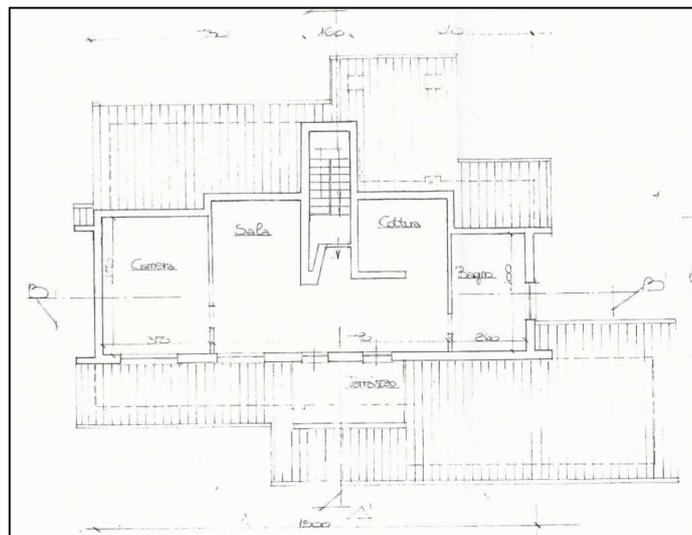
PLANIMETRIA DELL'APPARTAMENTO
